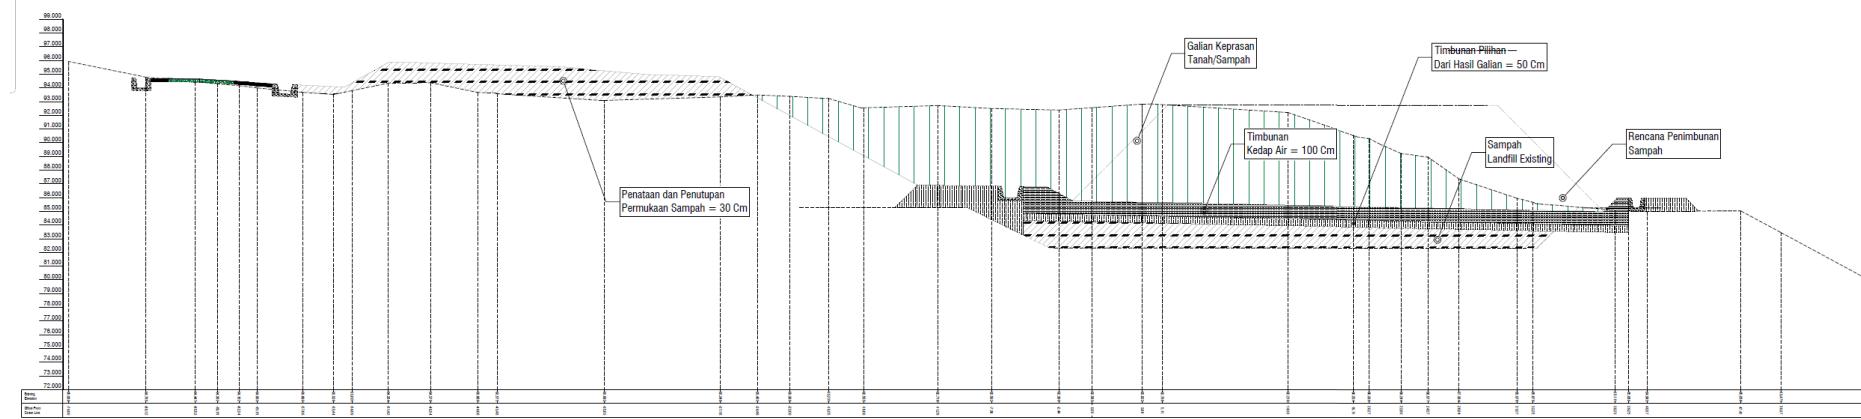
Geotextile Lapisan Kedap Air Landfill TPA
